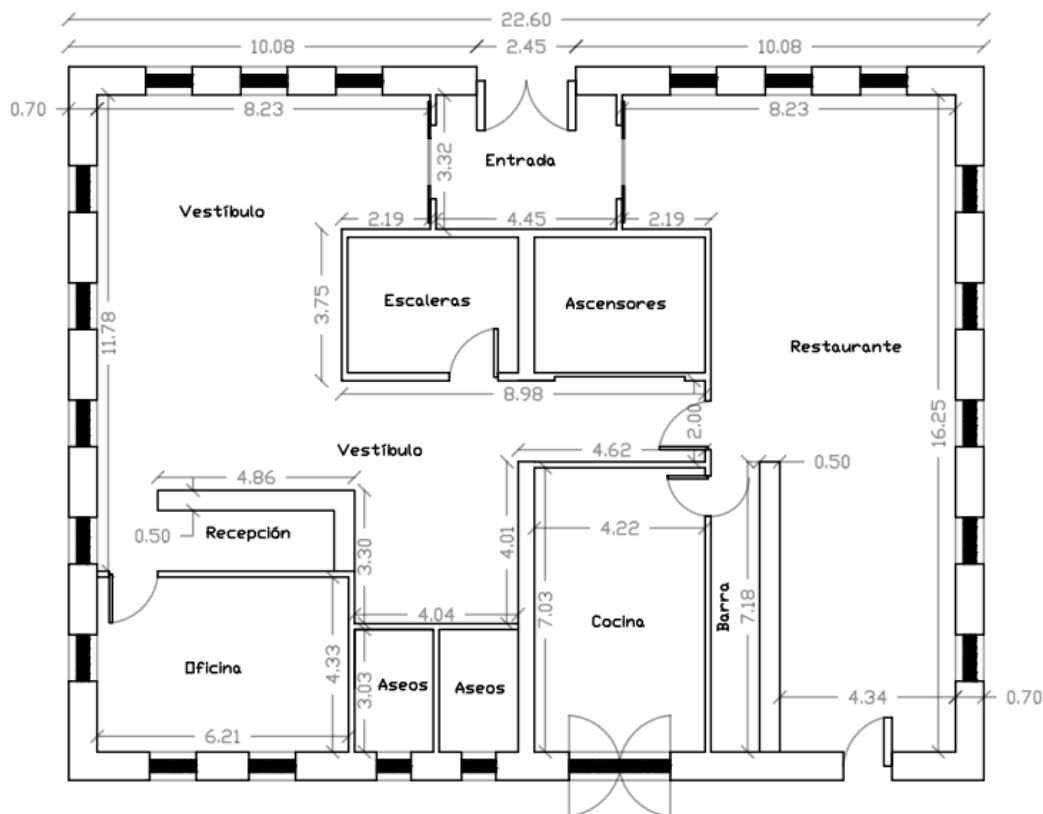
Extracto del plano de la planta baja redistribuida. Fuente: Elaboración propia
